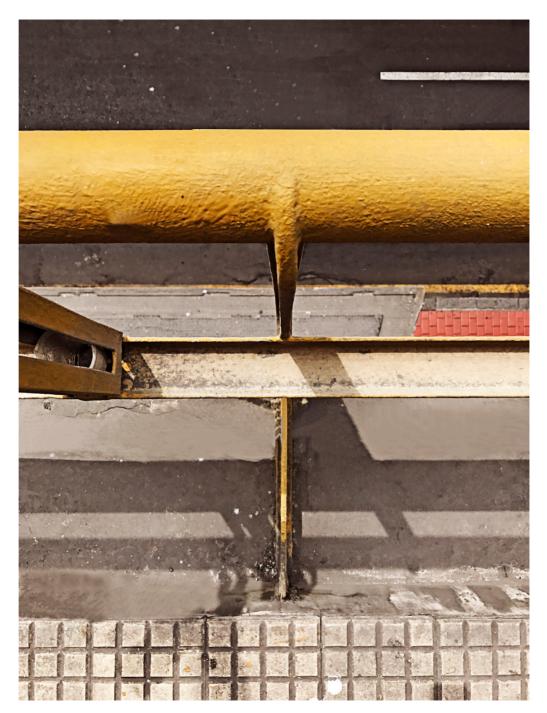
encuentro entre piso y baranda (2016) Fuente: muro\_arquitectos (2016) Digitalización: Ortiz, J. (2016)
